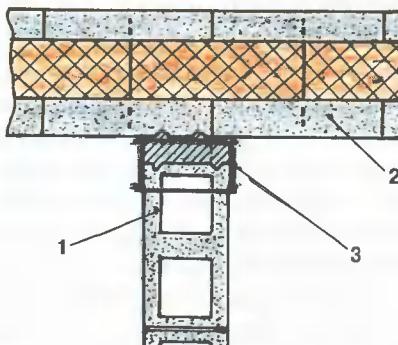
Соединение трёхслойной стены с внутренней стеной: 1 — внутренняя стена; 2 — внешняя стена; 3 — опалубка-компенсатор
